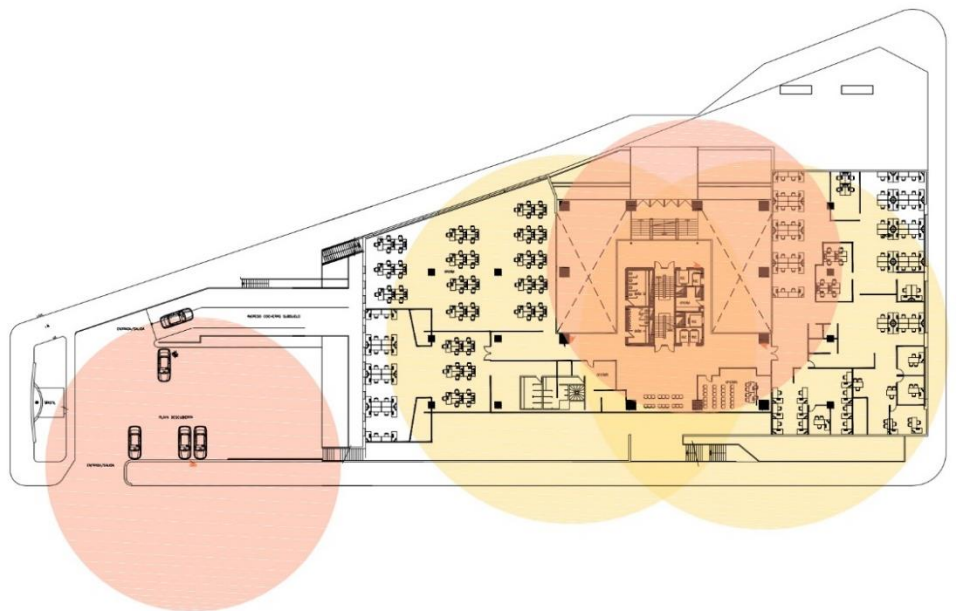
Radio de alcance de mangueras en la planta baja del edificio. El radio a cubrir de las mangueras es de 20 metros, a excepción de uno de los hidrantes que contara con una manguera de 25 metros para poder llegar a cubrir el área de oficinas (marrón). Se colocara 1 hidrante en el exterior, al lado del auditorio, para poder cubrir ese sector en forma independiente de los demás.
